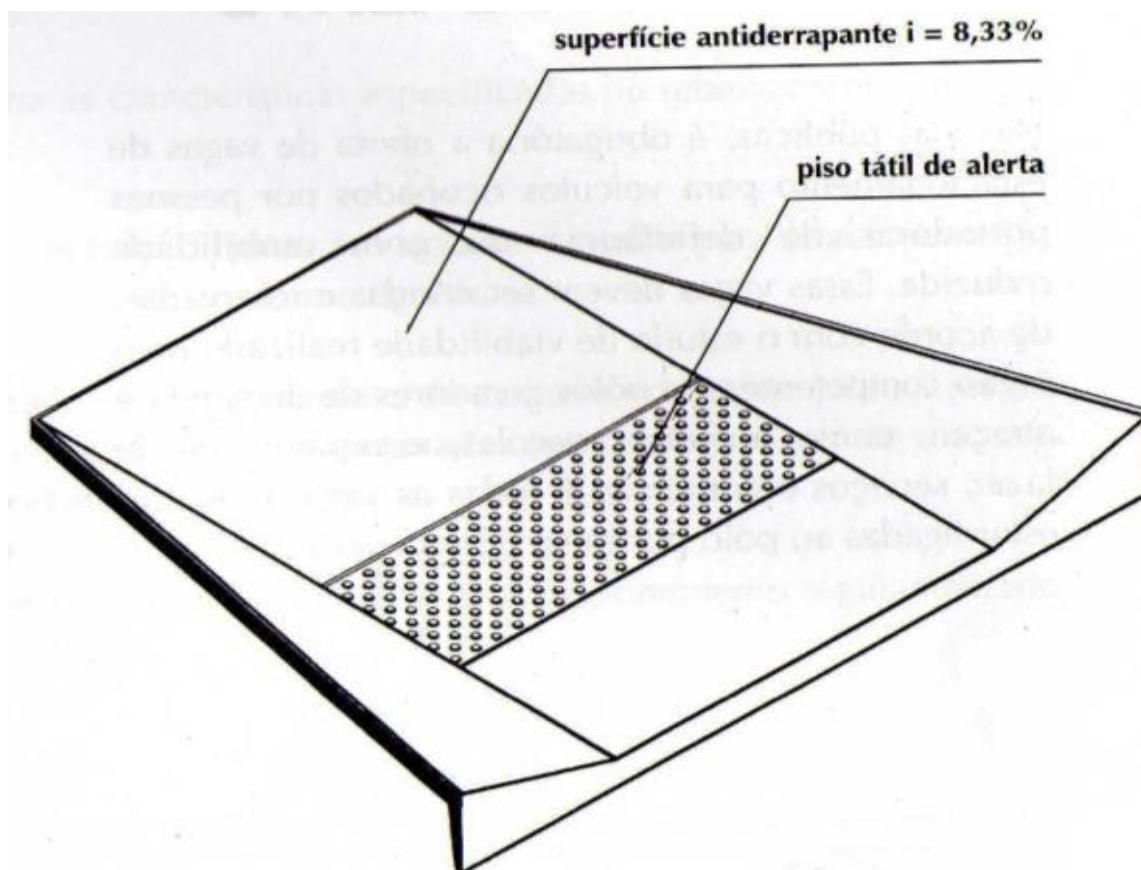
Rampa pré-fabricada para rebaixamento de calçada
